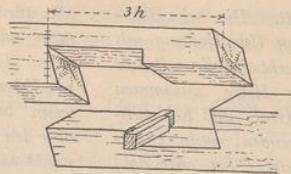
Das schräg geschnittene gerade Hakenblatt mit doppelten Keilen. Die Keile pressen die Hölzer fest an einander, sodaß auch einiger Widerstand gegen Durchbiegung geleistet wird. Diese Verbindung auch ohne Keile anzuwenden.
